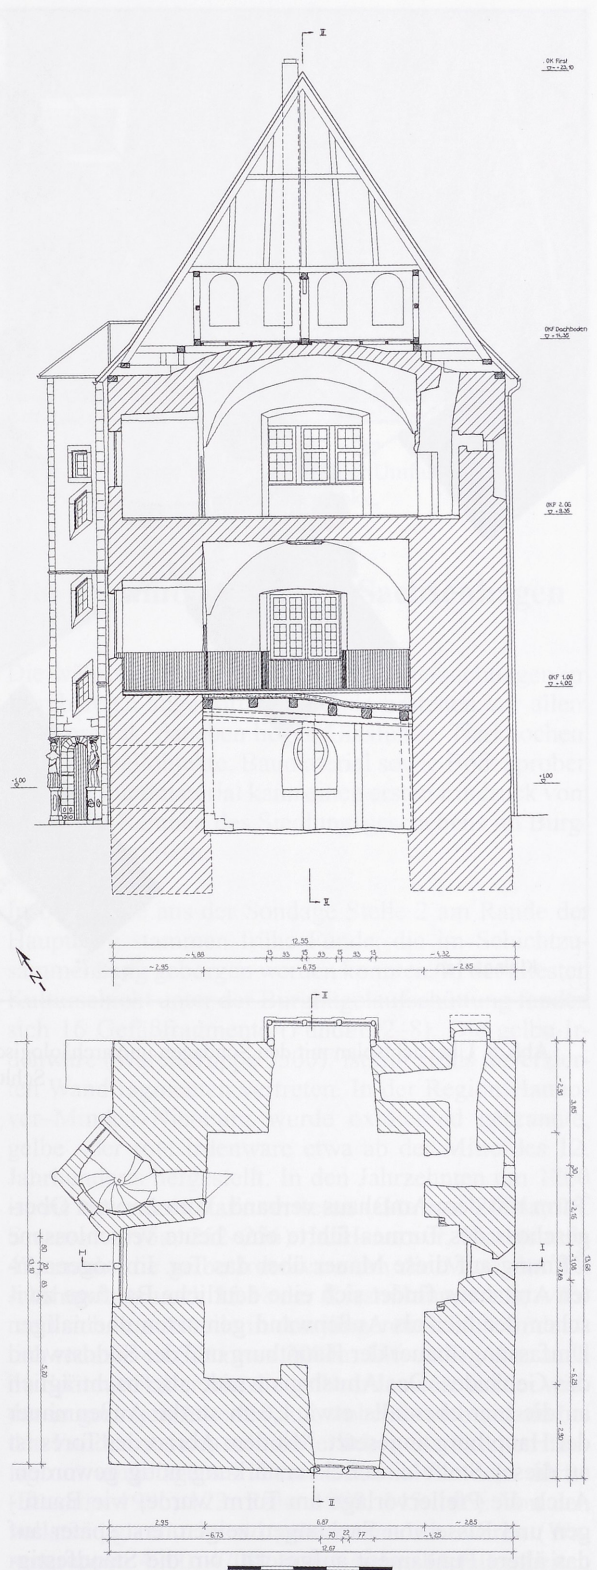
Schnitt und Grundriss des 2. Obergeschosses des Turmes.
